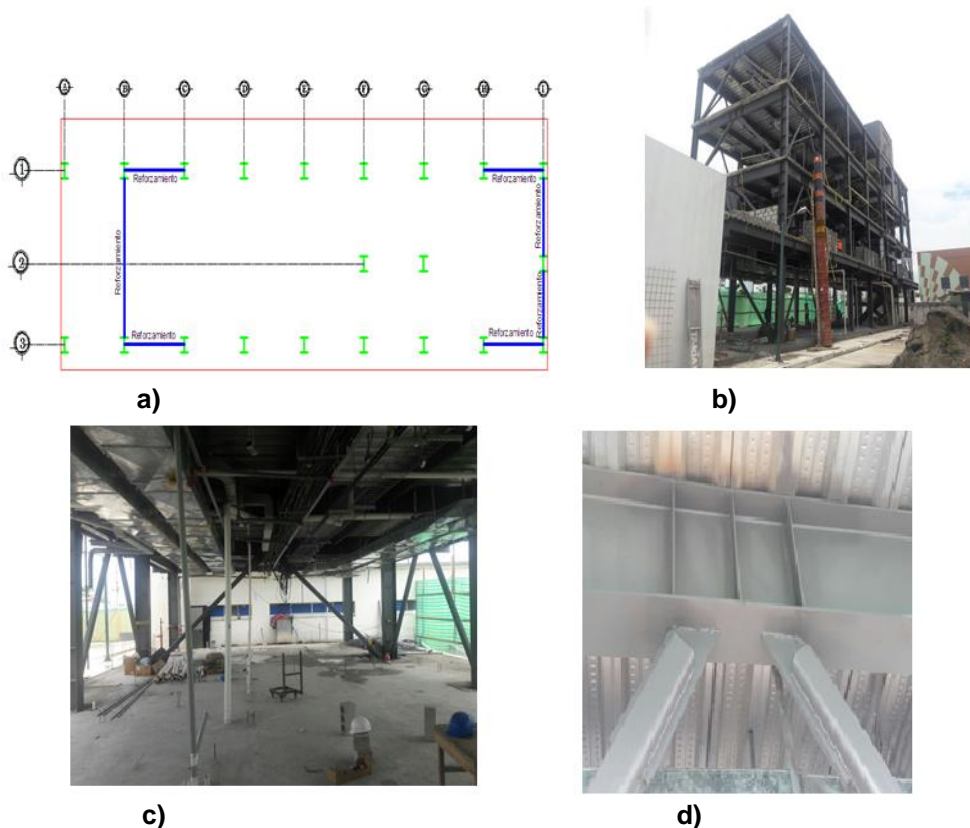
Reforzamiento de UVC; a) Planta de la Estructura; b) Vista en elevación en que se aprecian los contravientos; c) Contraviento en planta baja; d) Placa Gusset superior y placas de continuidad en el alma de la viga.
